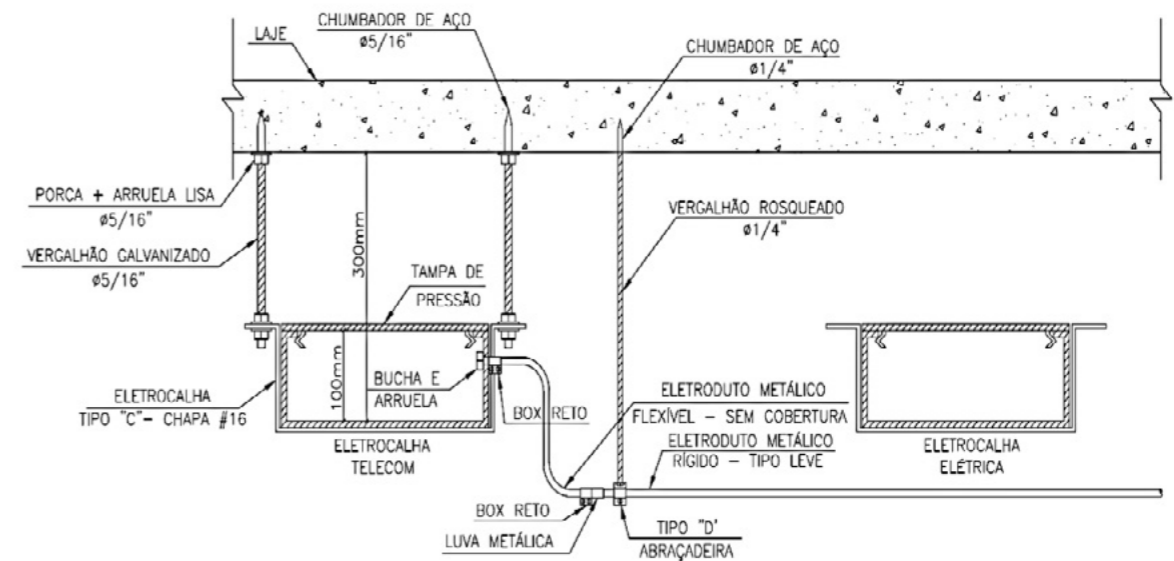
Fixação da eletrocalha em laje e desvio inferior do eletroduto
